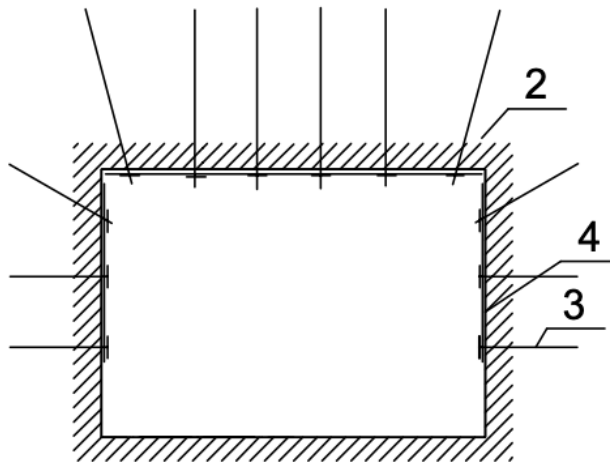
Поперечное сечение выработки на втором этапе
